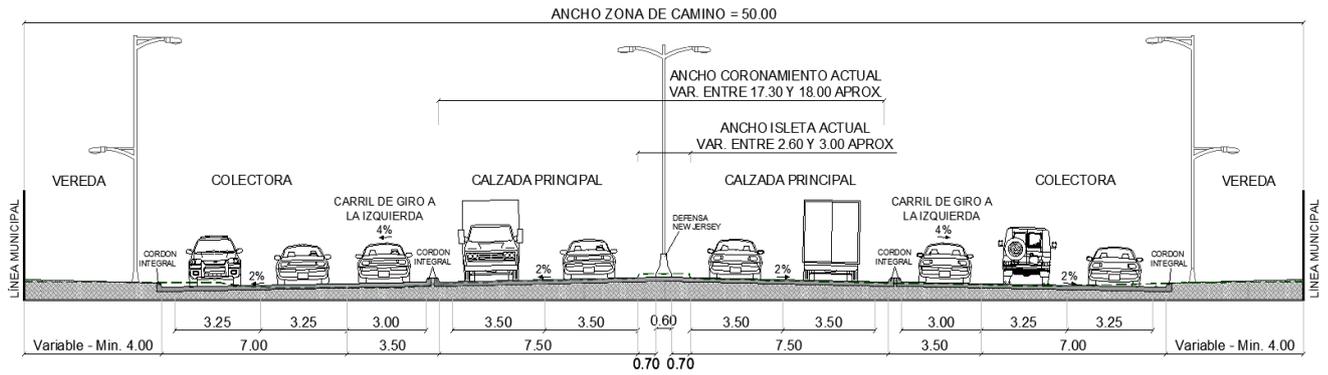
Perfil tipo de Obra Básica Zona Intersección Av. Illia
